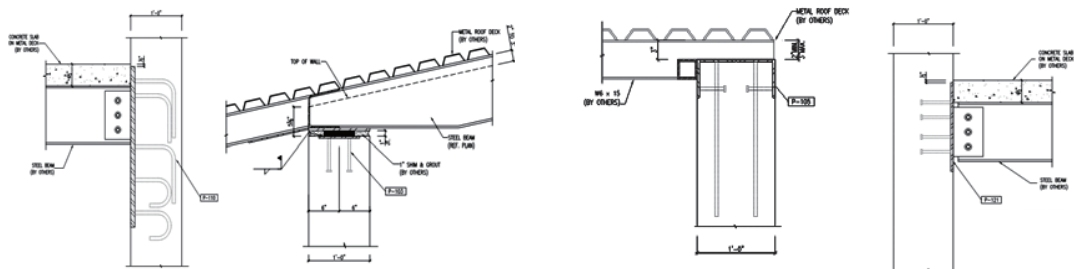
プレキャストコンクリートコアと鉄骨部材接合部例
